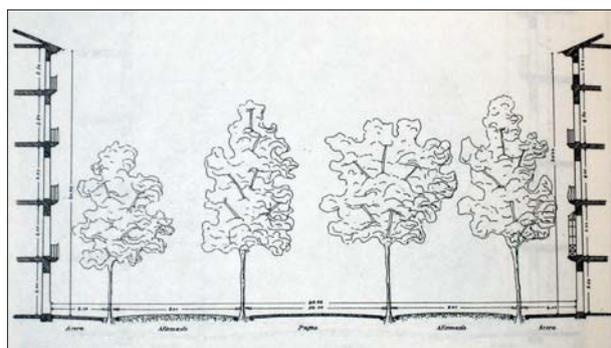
Proyecto de ensanche para Palma (Calvet): sección de las calles de primer orden
